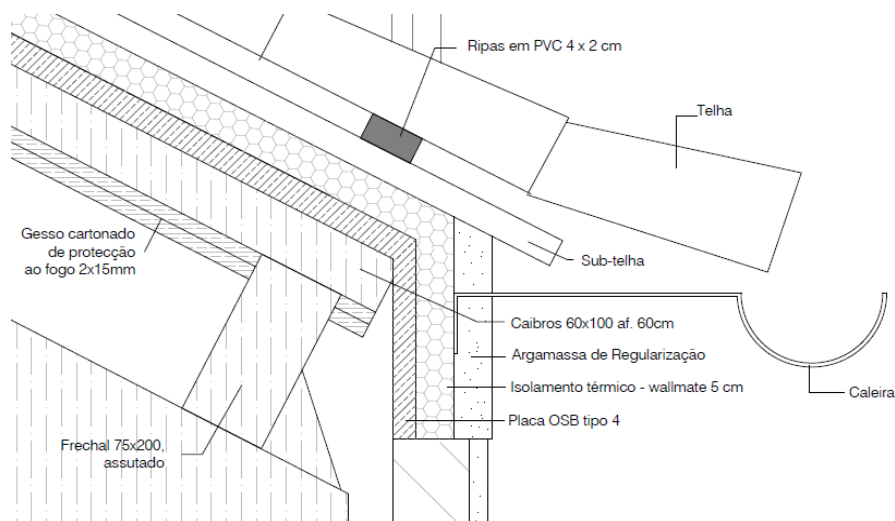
Pormenor da Cobertura (Fonte: Porto Vivo, SRU)
